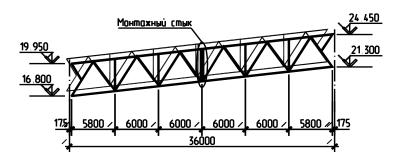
Схема фермы с габаритными размерами
